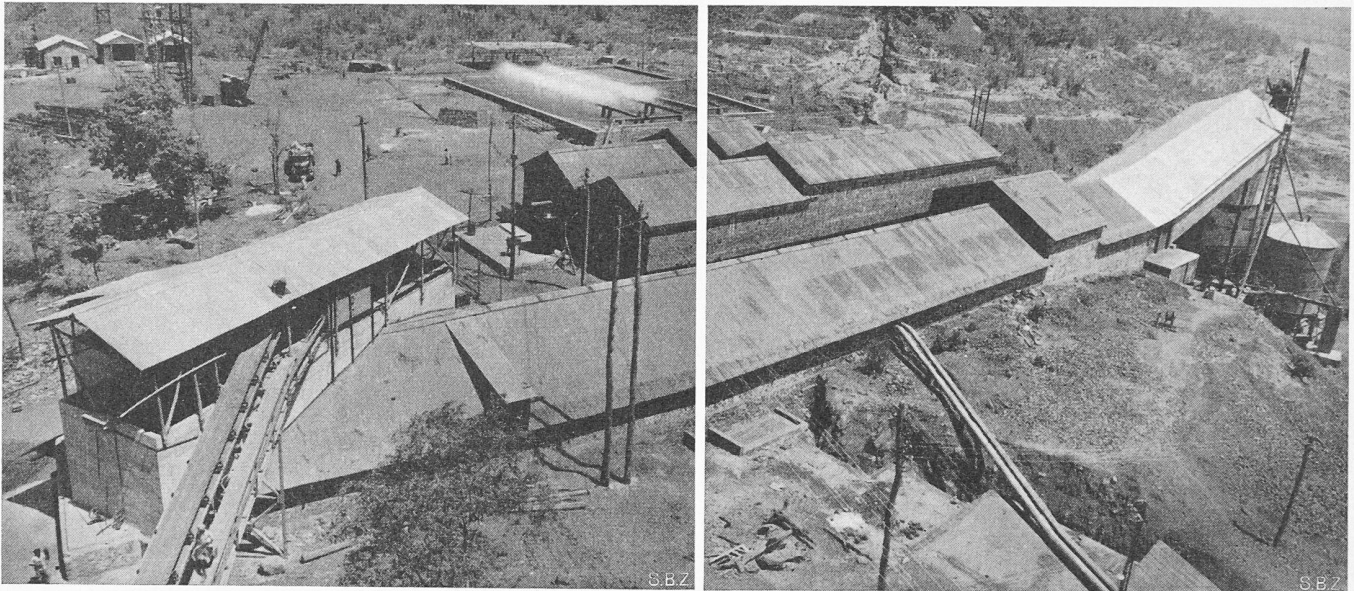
Kühl tunnel 8 (Mitte, vorn), links davon Förderband 4 und Empfangsbunker 6, rechts Betonmaschine mit Zementsilo, hinter dem Kühl tunnel Maschinenhaus, darüber das Rückkühlwerk 12 (siehe Legende zu Bild 1)
